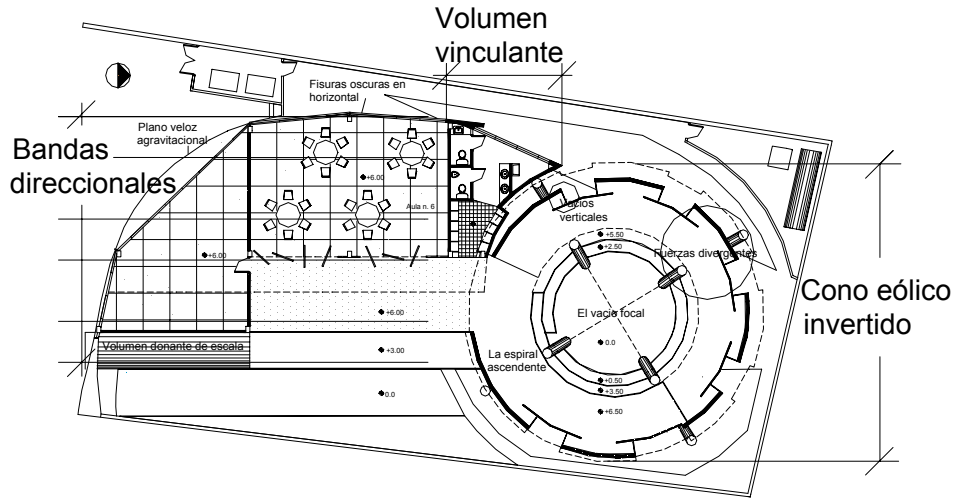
Planta indicadora de elementos que constituyen el concepto.
